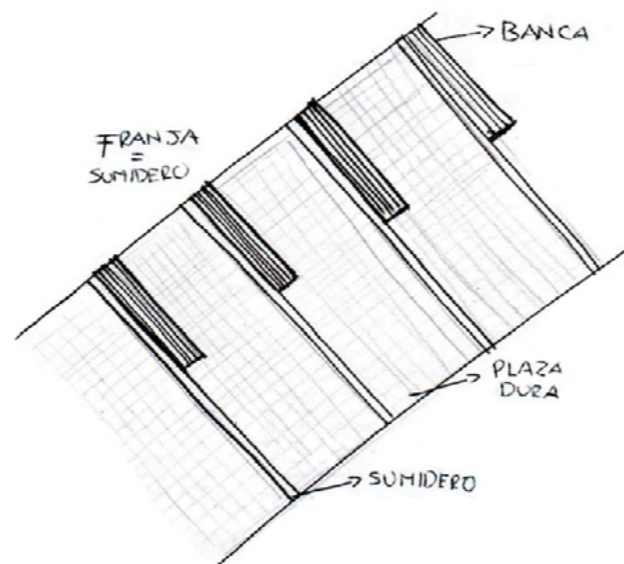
Modulación Pavimento duro + Bancas . Fuente propia
